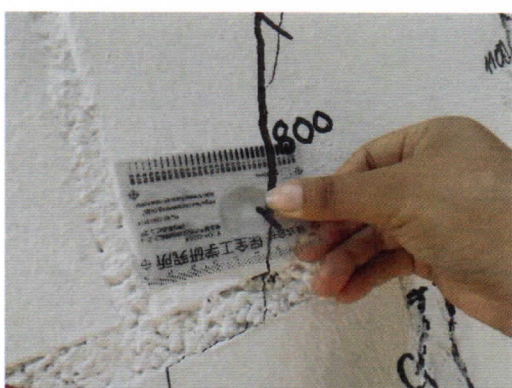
Espesor de grieta de 1.60mm en ladrillo de la cara Norte para una distorsión de 1/400.
